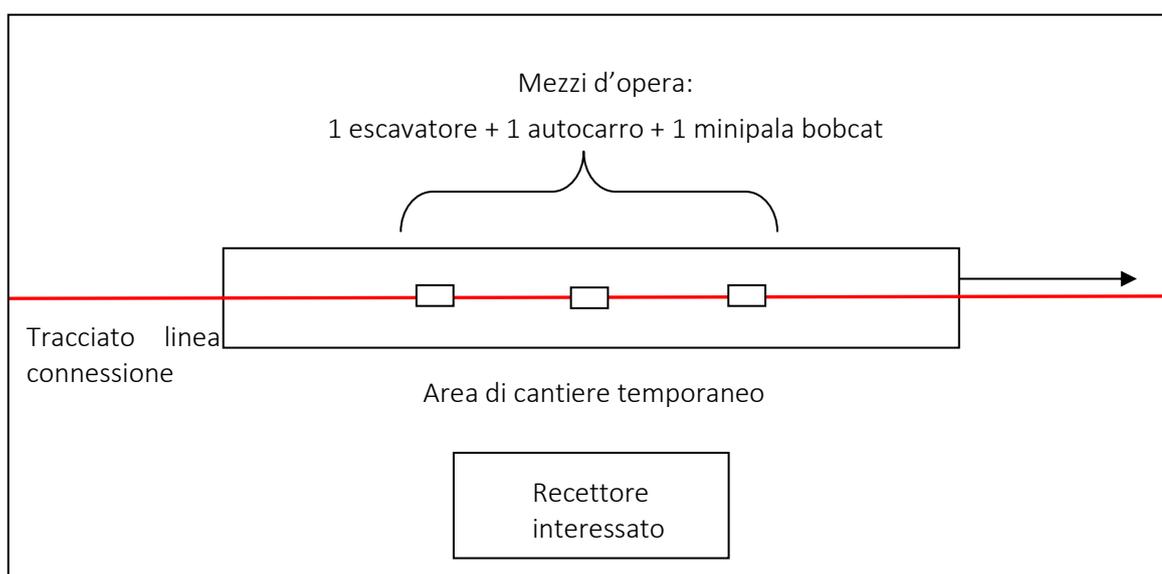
Rappresentazione schematica dell'area di cantiere durante le lavorazioni
